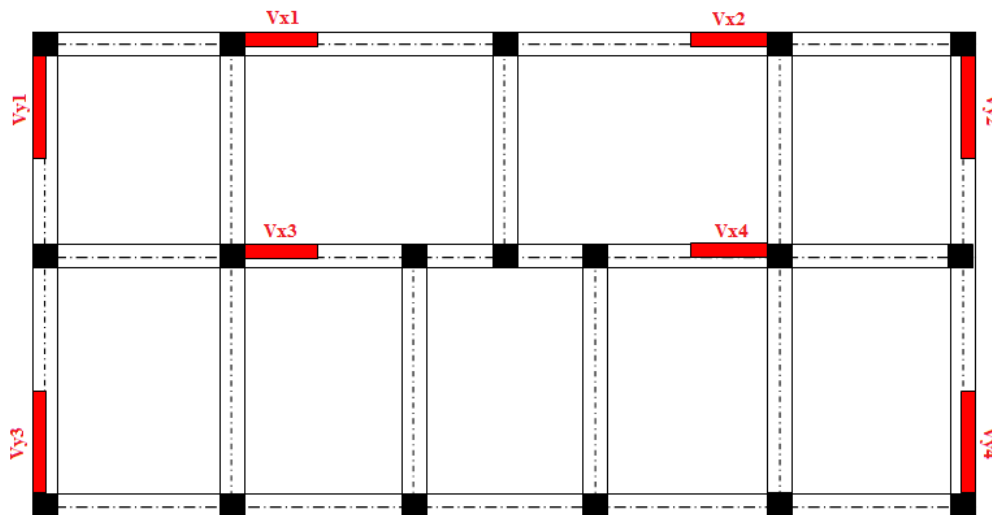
Disposition des voiles de contreventement pour l'ossature en béton armé.
